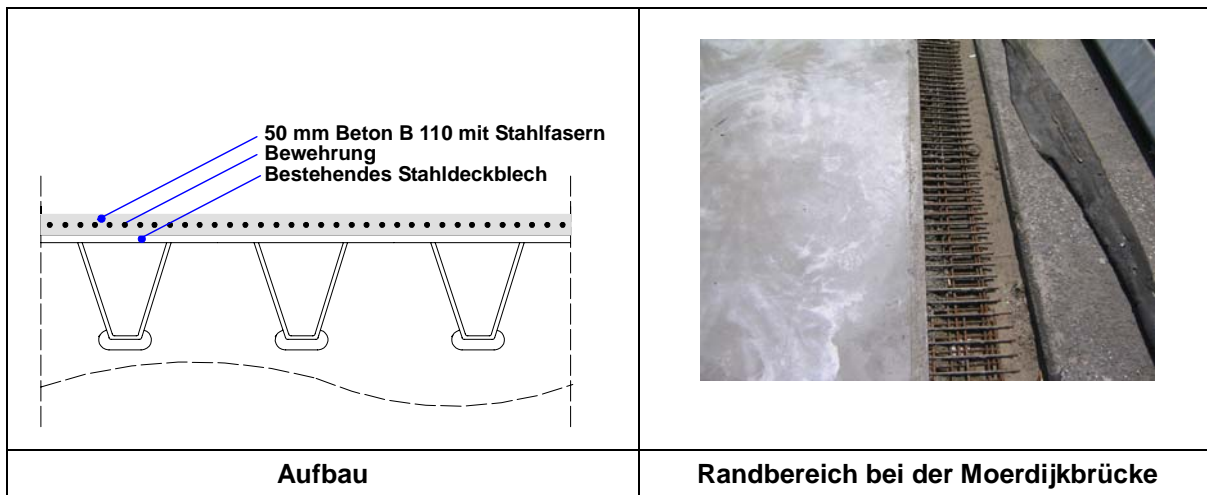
Hochfester mit Stahlfasern und Armierung bewehrtem Beton als direkt befahrener Fahrbelag
